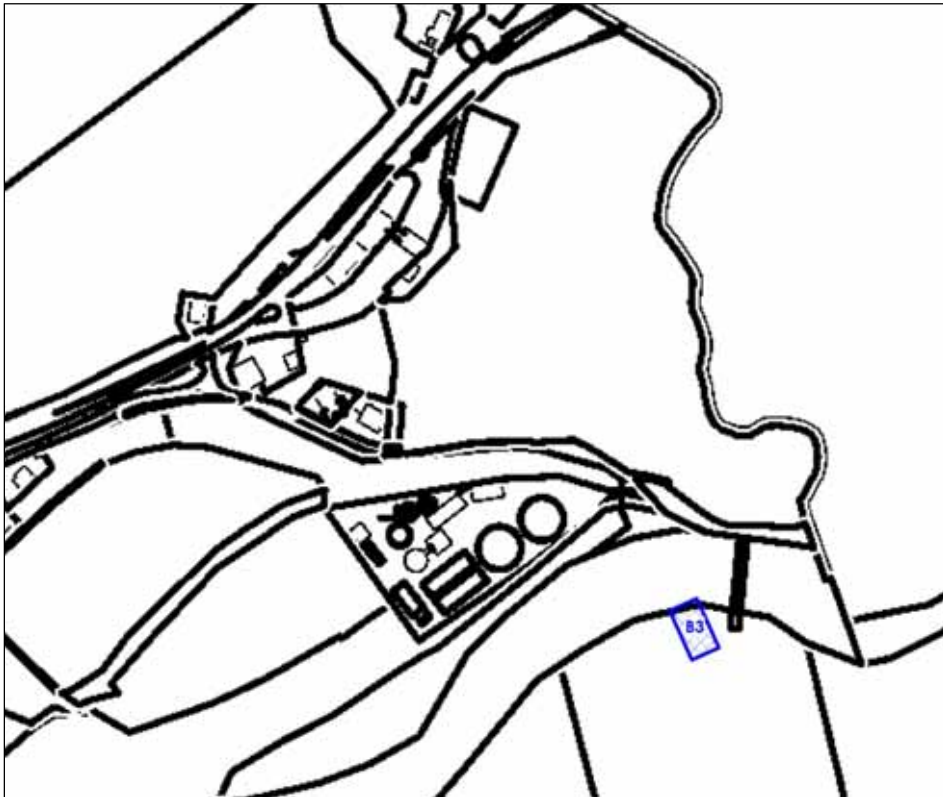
Lageplan mit Darstellung der Schallquellen für den Baustellenbetrieb V4
